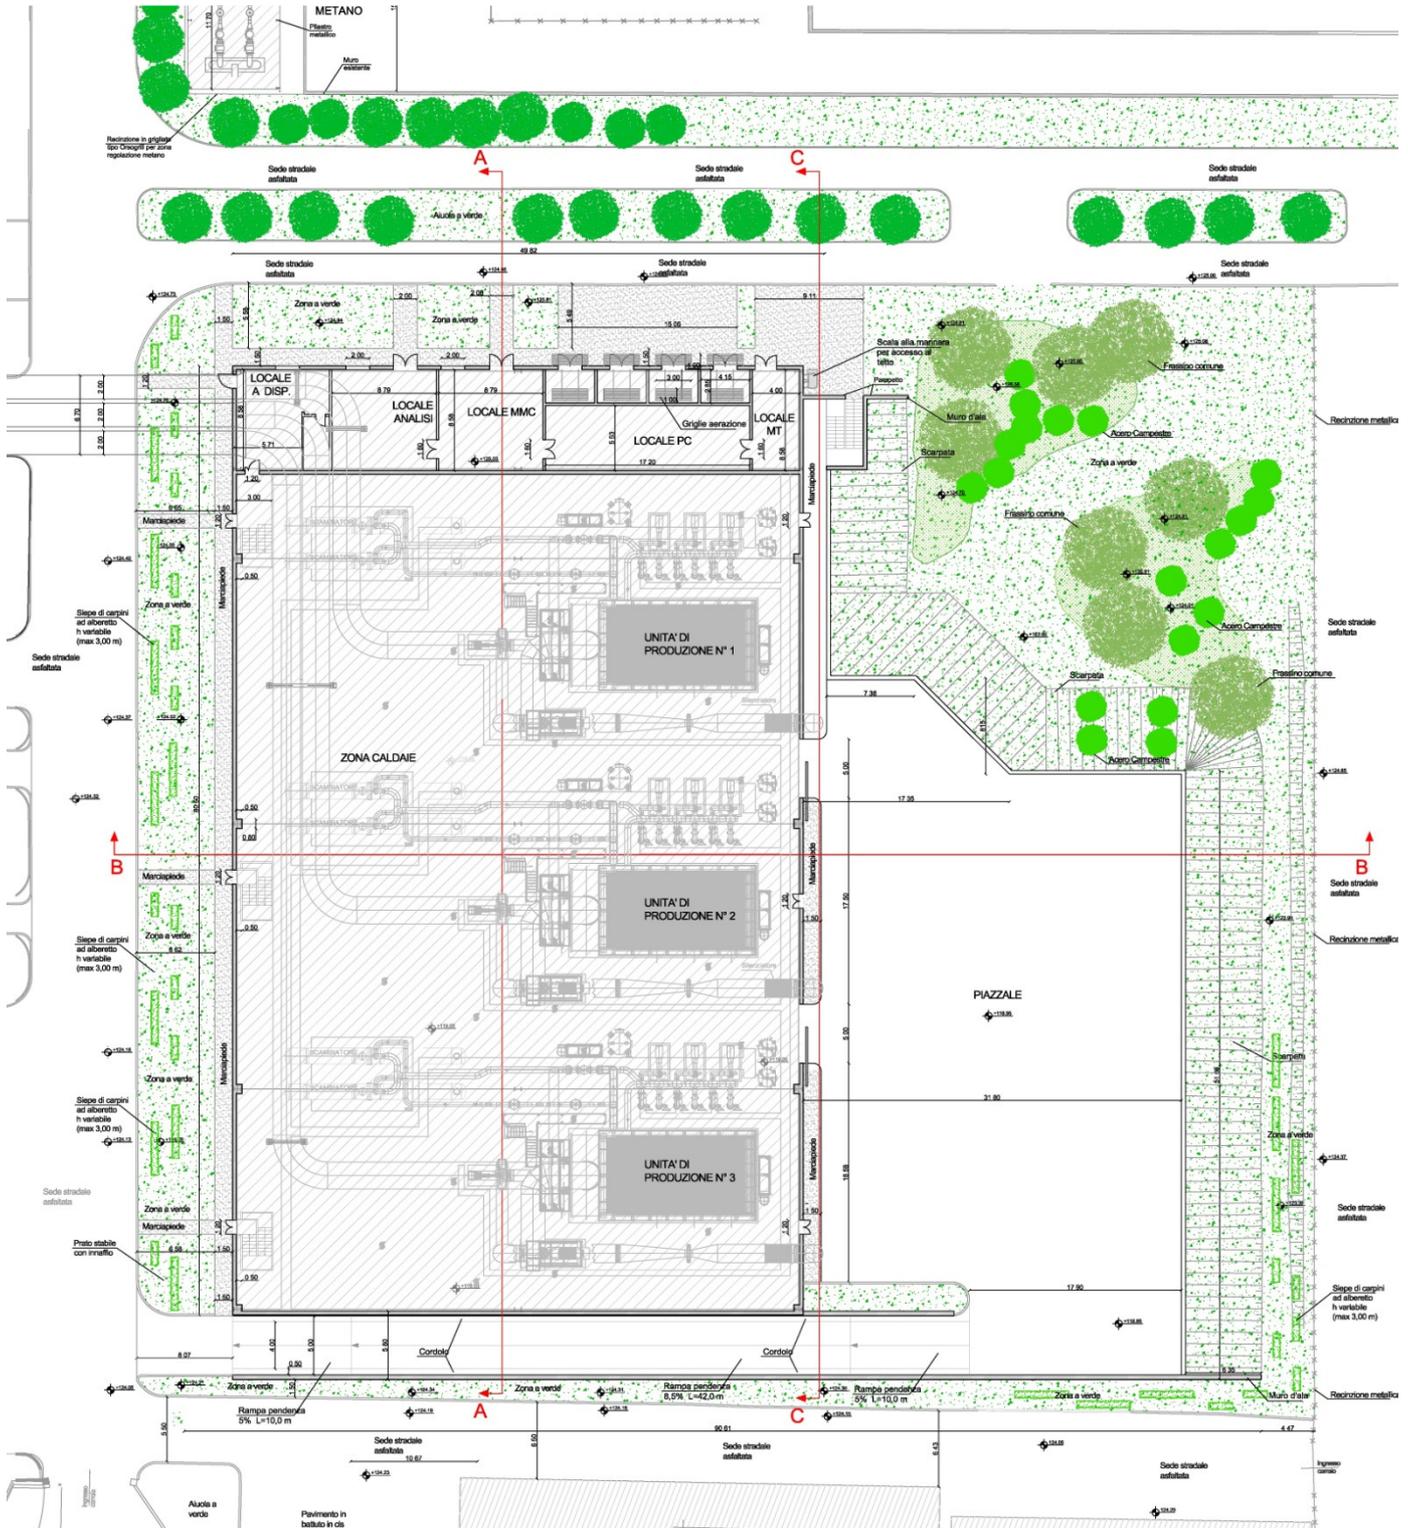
Pianta progetto edificio con progetto del verde esterno.
